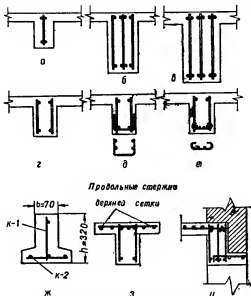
91. Поперечные сечения балок, армированных сварными каркасами: а — и — типы армирования.
